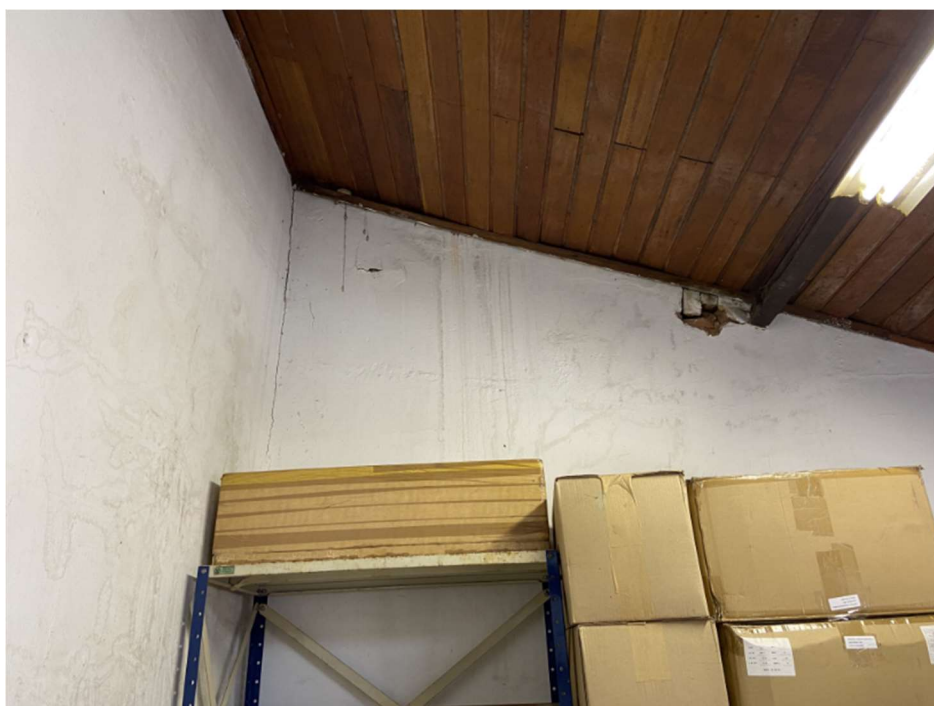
Parede da despensa da cozinha. Notar fissura que indica que a parede frontal a parede está de destacando da parede da esquerda. A arquibancada está a direita da foto.
